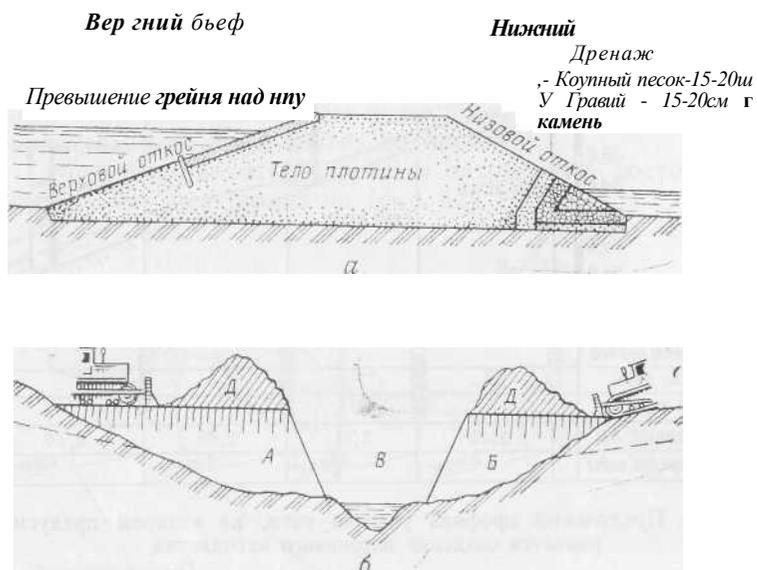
Земляная плотина: а — поперечное сечение; б — схема возведения
